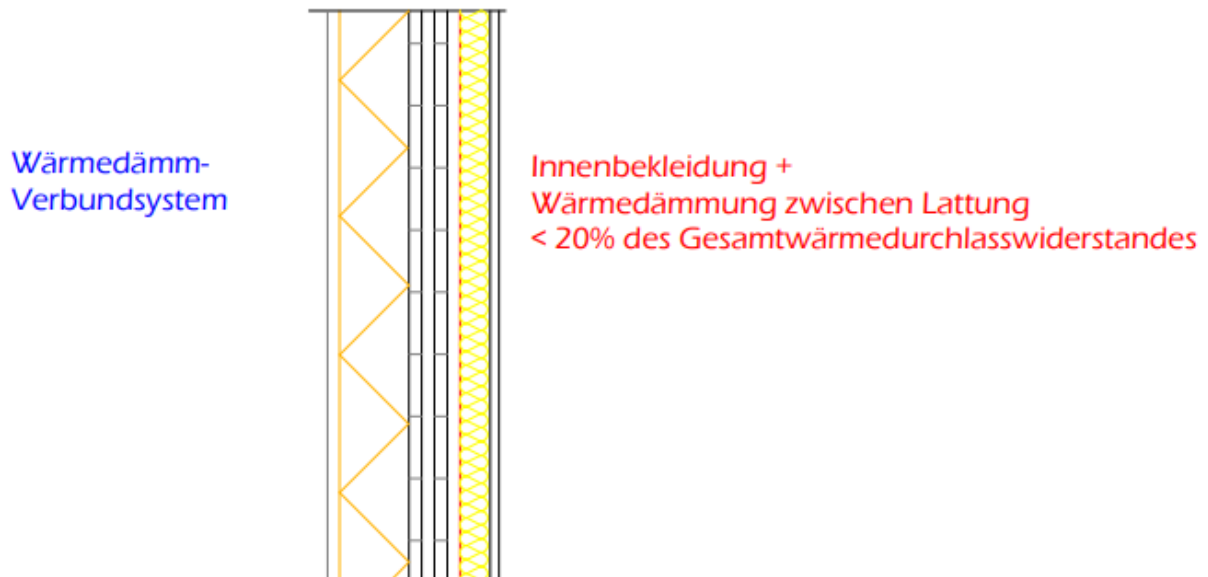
Holzmassiv-Außenwand mit innerer und äußerer Wärmedämmung
